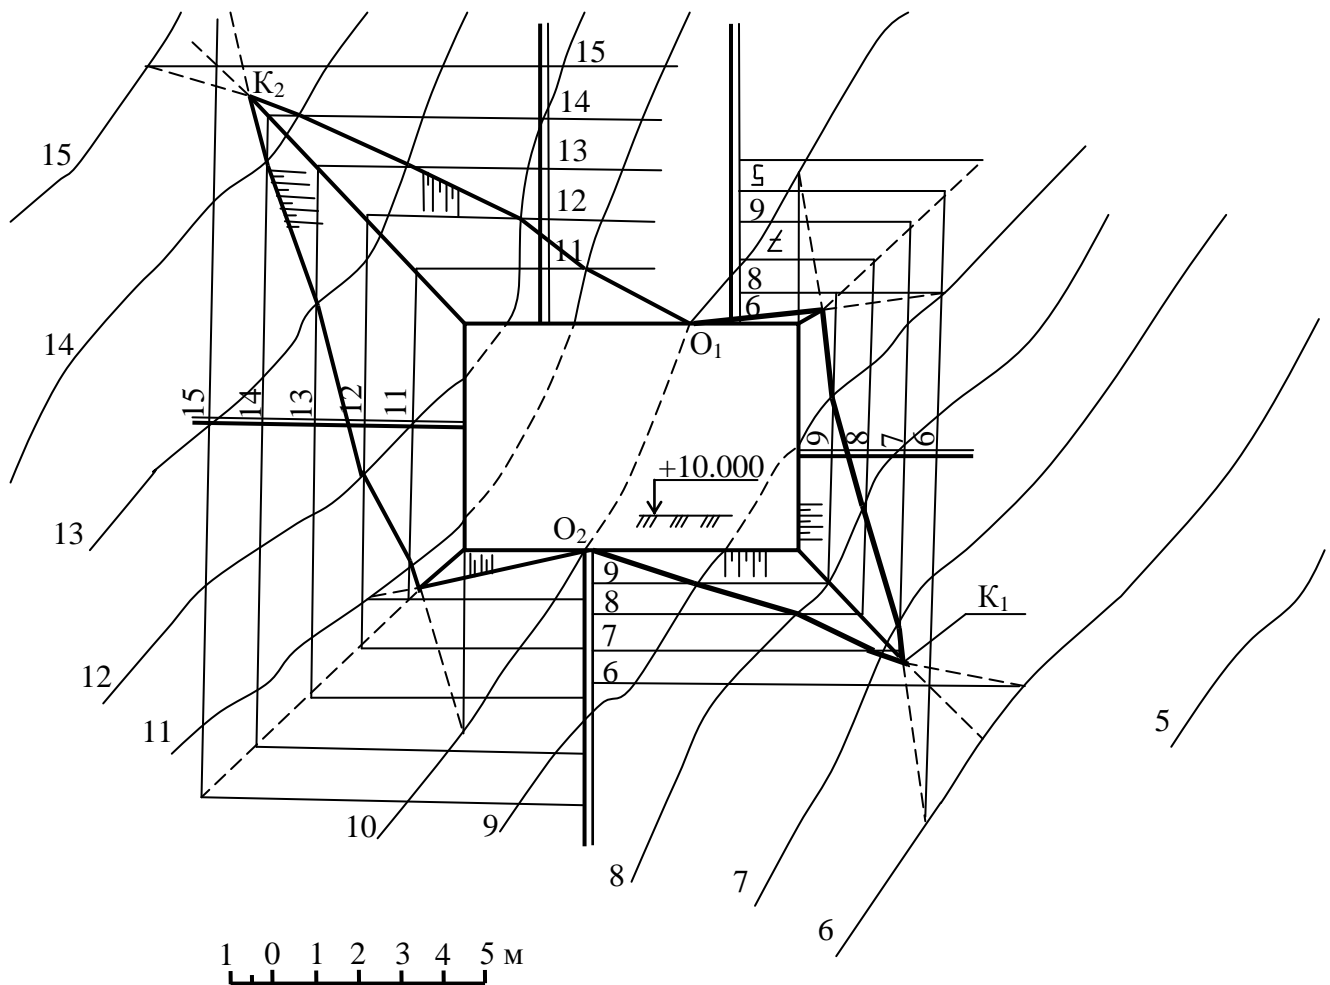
Определение границ земляных работ по устройству насыпи и выемки
